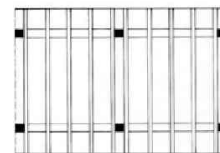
Planta baixa com os pilares do sistema (Frampton, 1979). S/ esc.
